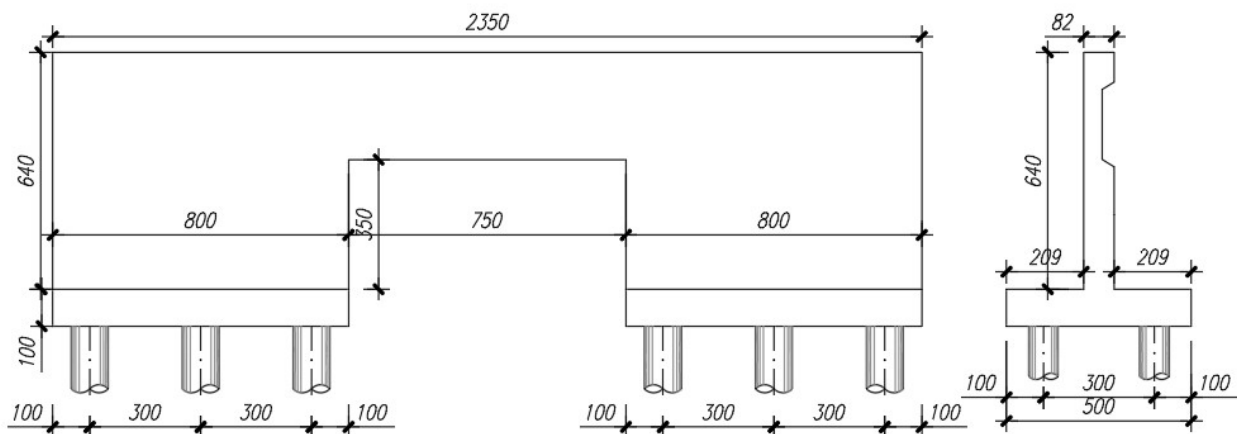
Prospetto e sezione portale di scavalco L=7,50m
